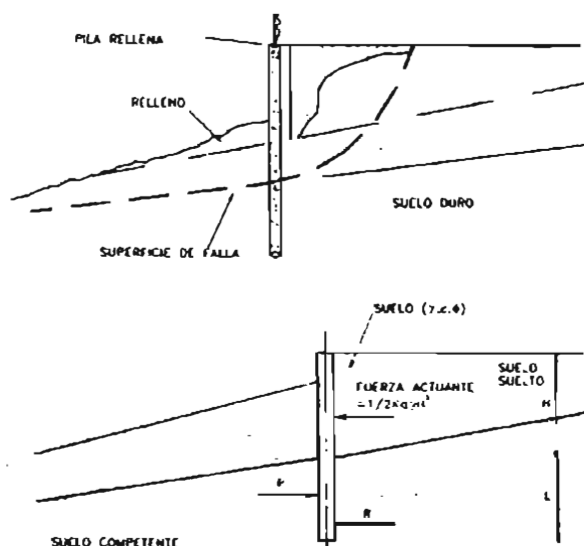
Esquema del planteamiento de una pila como muro de contención.
